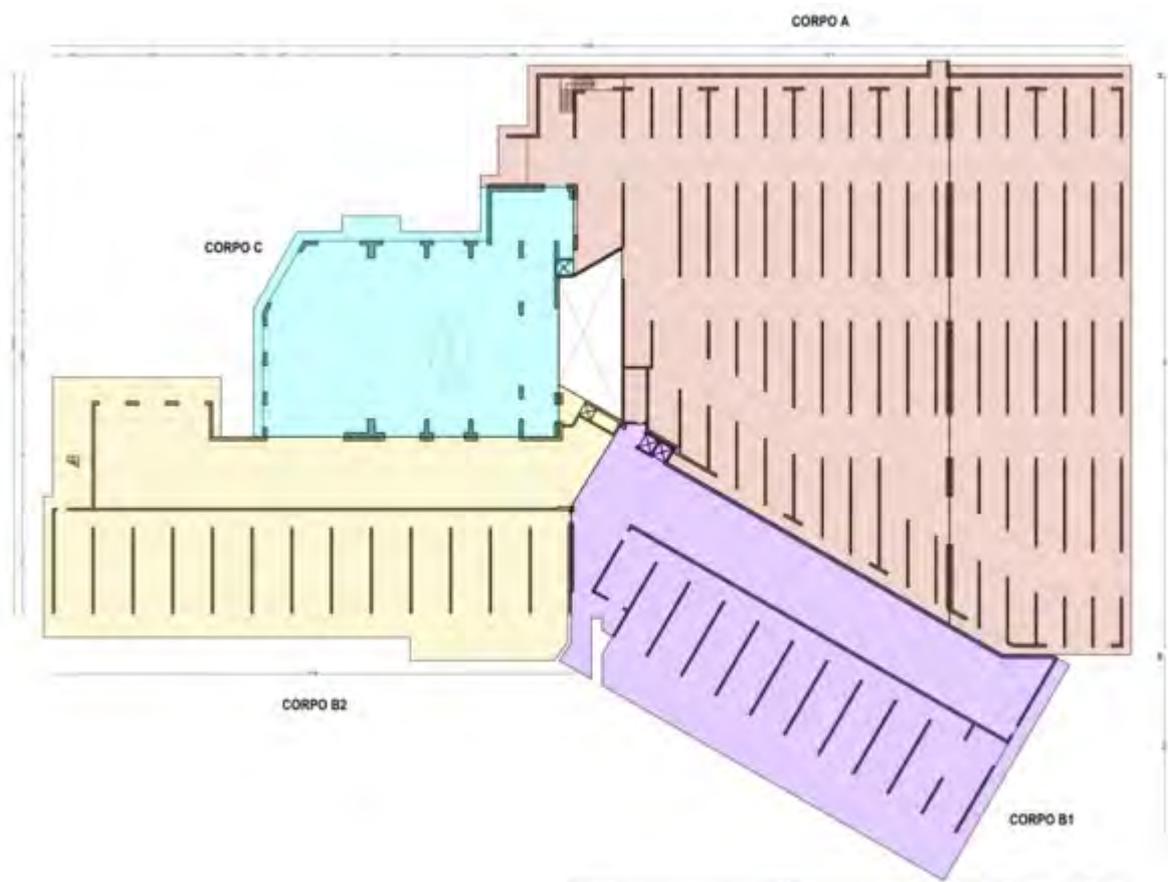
Suddivisione in blocchi funzionali del progetto strutturale originario – piano terra.
